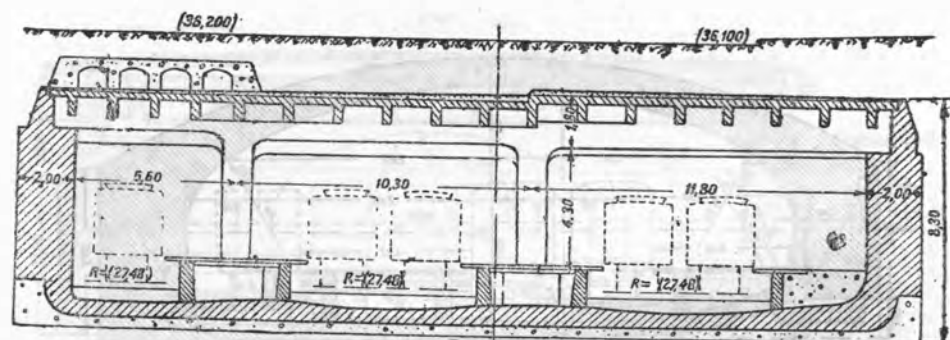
Конструкция станции „Сен Клу“ с плоским железобетонным перекрытием при двух островных платформах и одной боковой. Общая ширина профиля—31,70 м.
